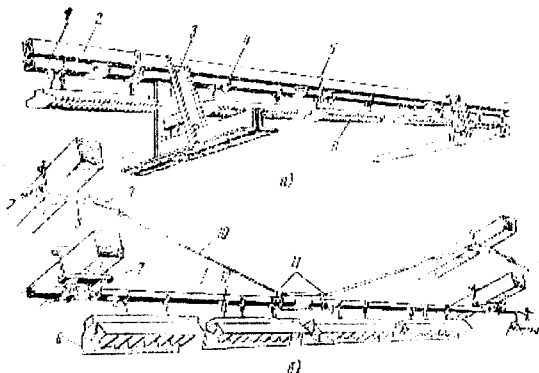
Прокладка шинопроводів ШОС4 поперек ферм:
